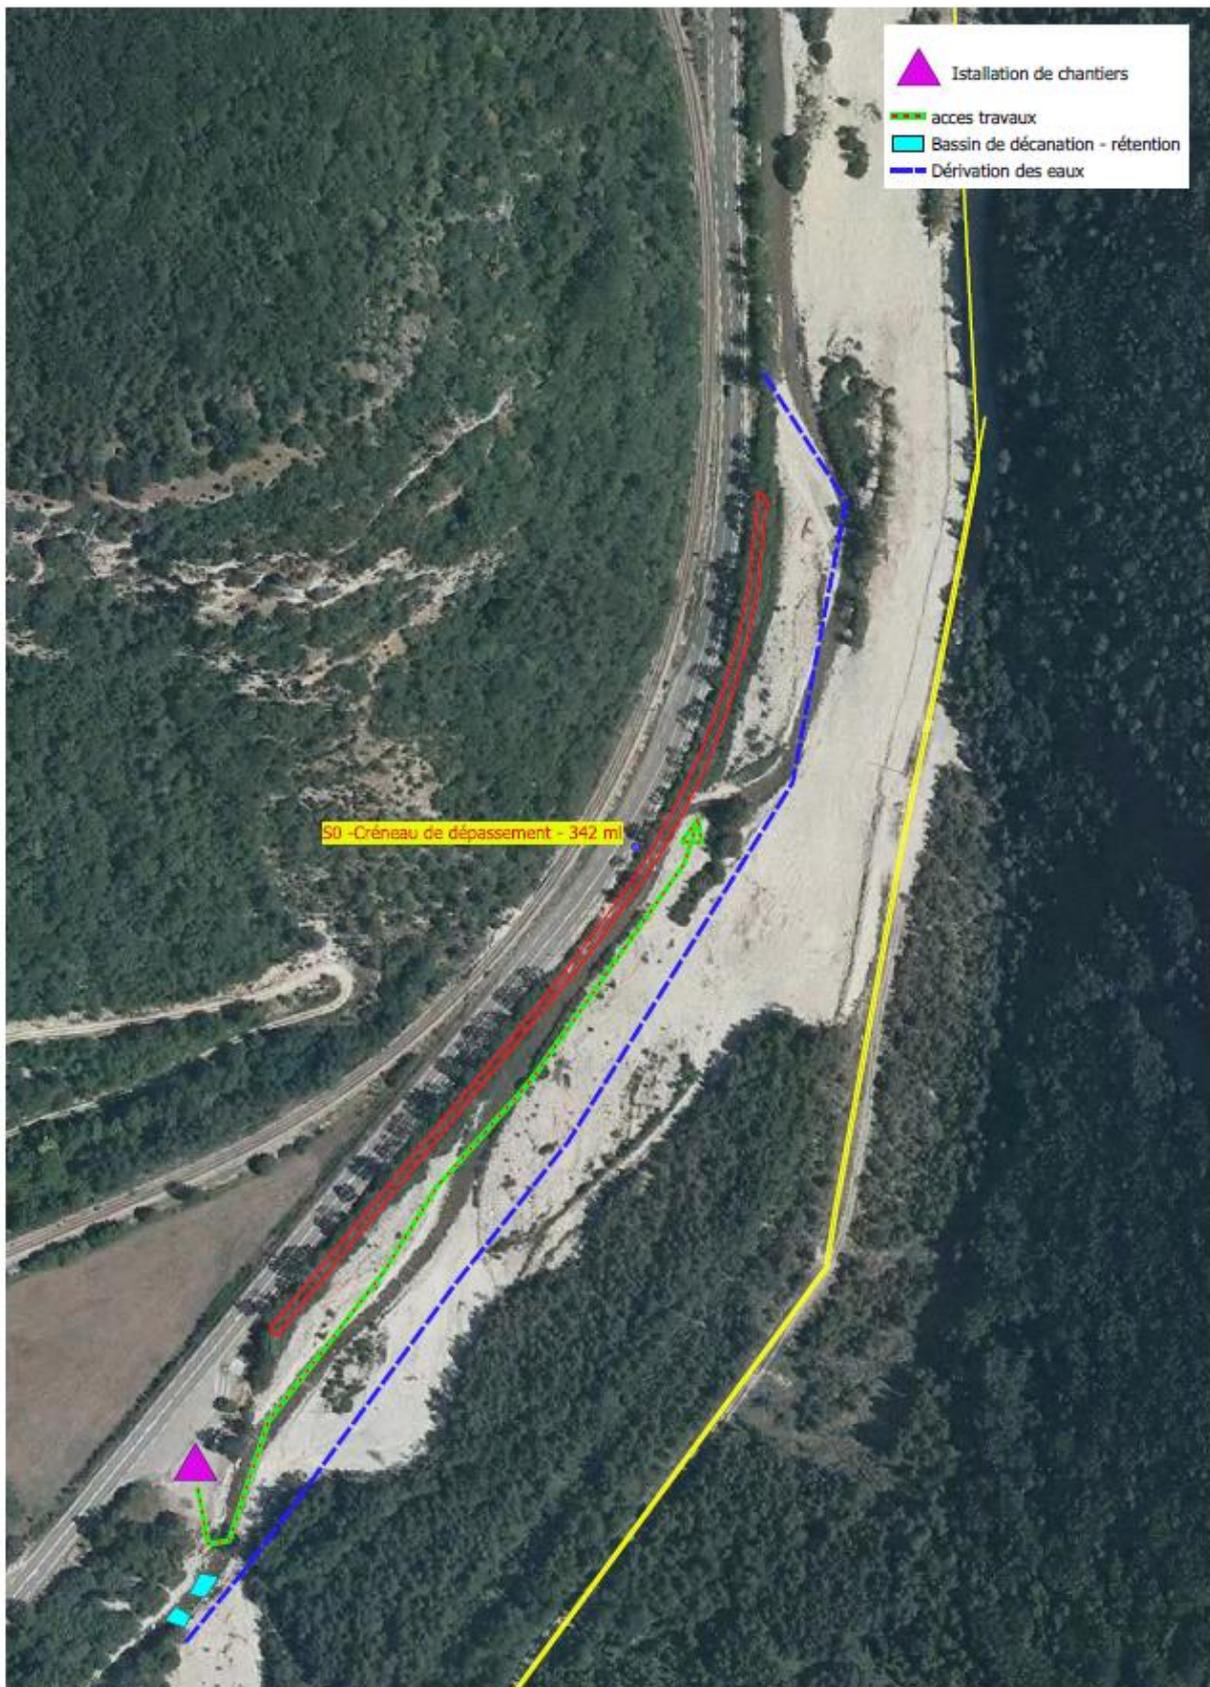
Site 0 : accès, installation de chantier et dérivation
